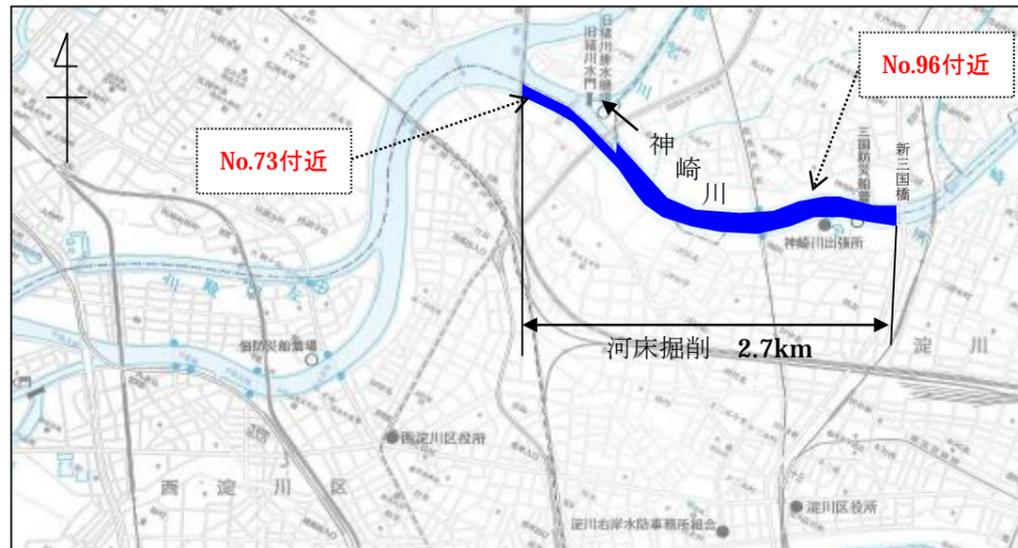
神崎川河床掘削平面図 (猪名川合流点付近～新三国橋下流)
